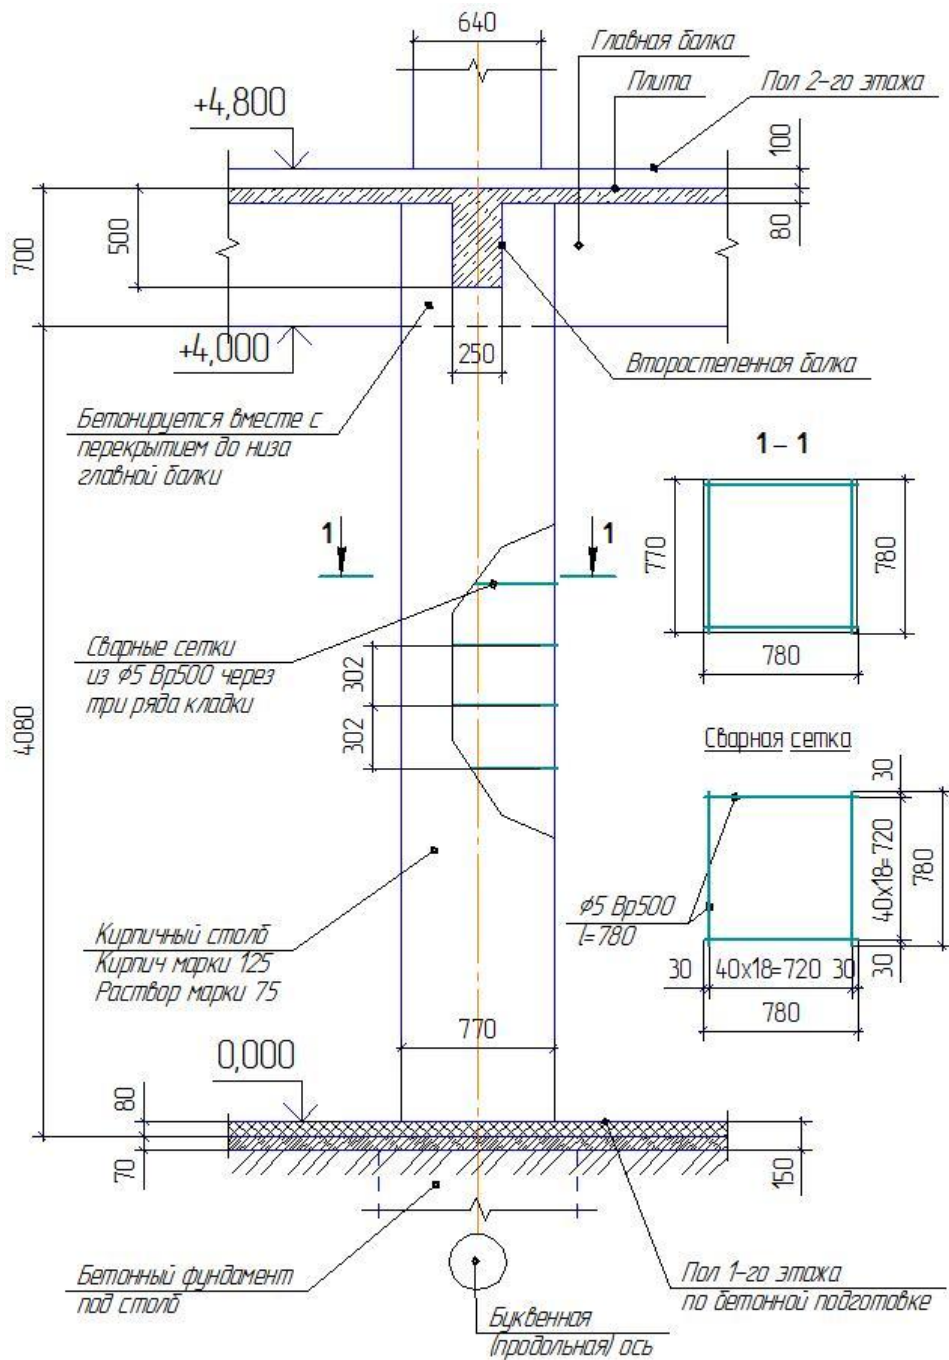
Кирпичный столб первого этажа армированный сварными сетками (к примеру 2)
